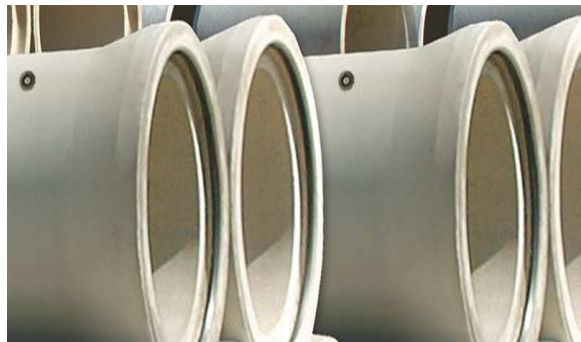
Conduite assainissement en béton armé série 135 A - Ø 300 mm à 2000 mm
